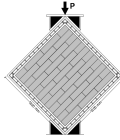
5 Sampel Dinding Tipe *Reinforced Concrete Frame Infill Masonry Wall
